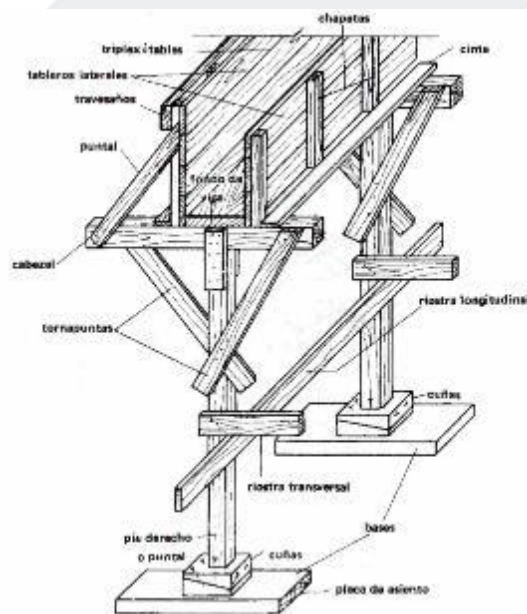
Diseño encofrado para vigas. Fuente Sena.
